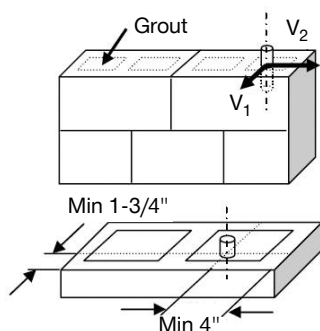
Instalación en una unidad de mampostería de concreto relleno con grout
